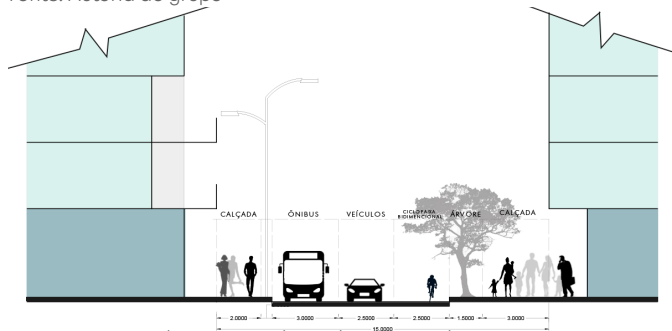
Corte da proposta de reurbanização da Rua Prates
